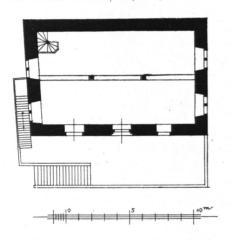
Rathaus zu Gelnhausen. Grundriß im Erdgeschoß. Nach Bickell, Bau- u. Kunstdenkmäler in heffen-Raffau.
